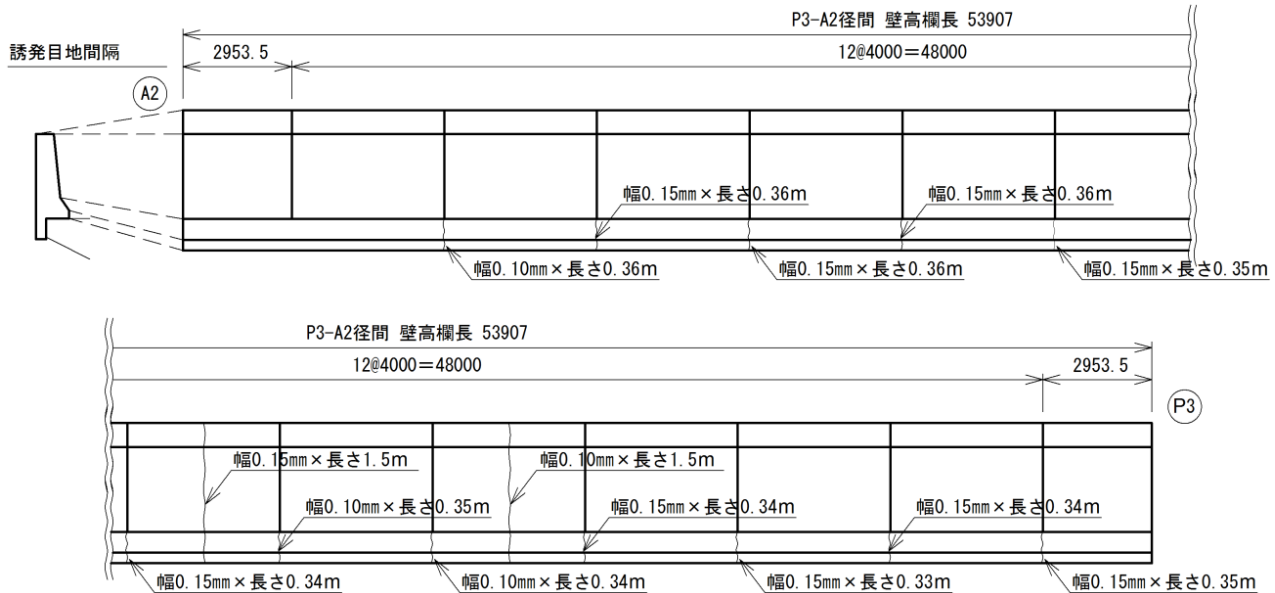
ひび割れ発生状況 (P3-A2 径間 右側壁高欄 内側)
